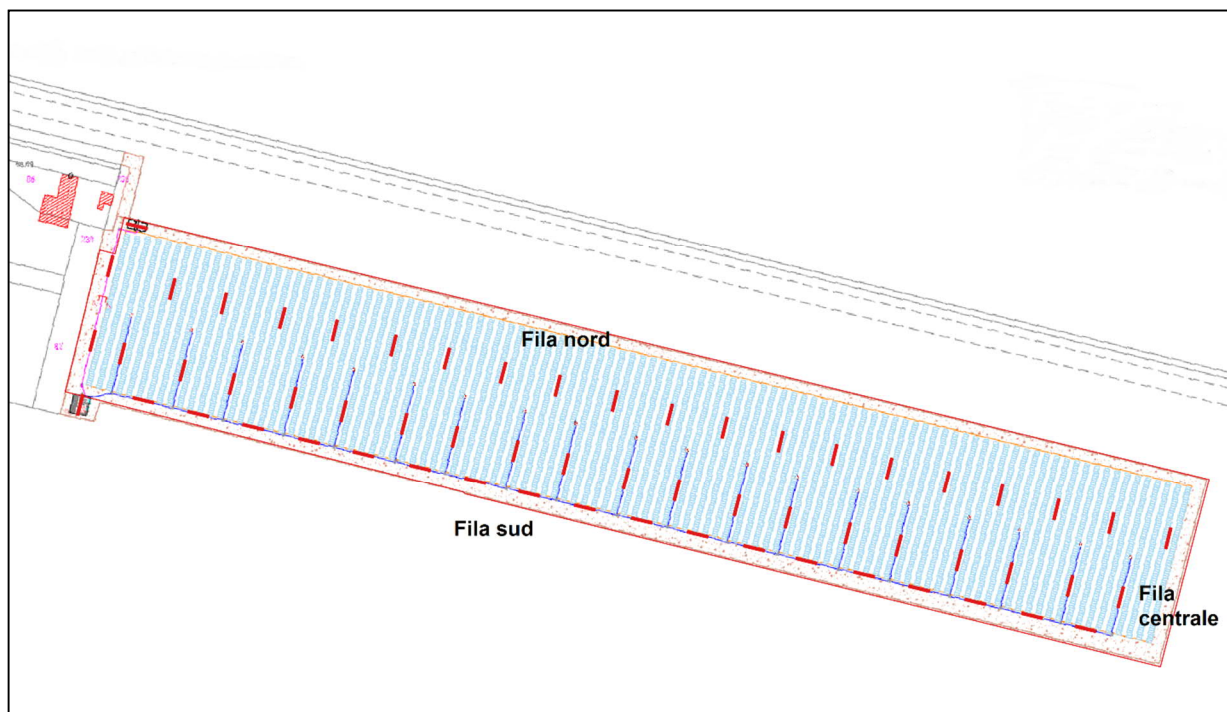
Planimetria con la disposizione del progetto iniziale dei sondaggi.
